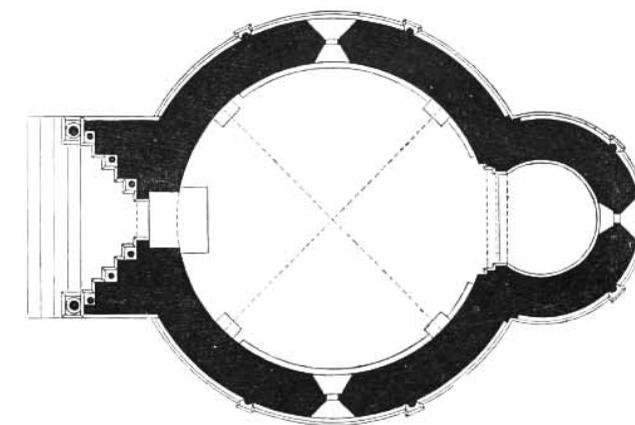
Grundriss Bad Deutsch Altenburg, M 1:200. MdkkCC 12/1867, 157.
